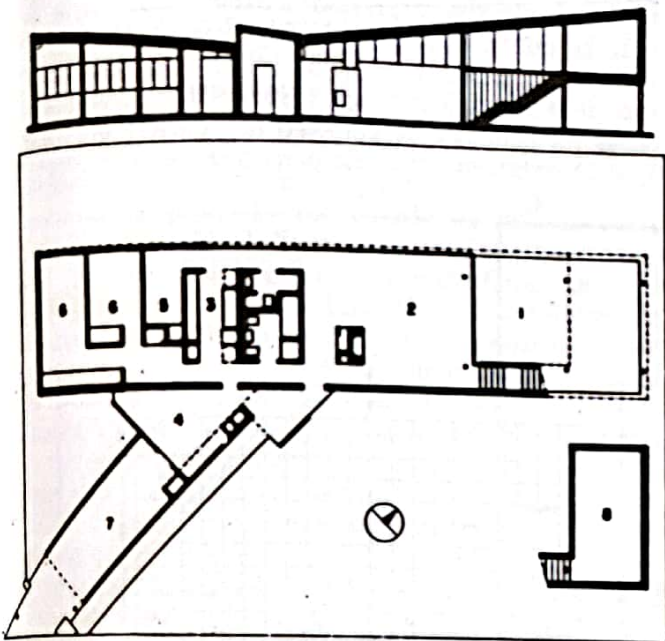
João VILANOVA ARTIGAS. Casa do arquiteto. São Paulo. 1948-1949. Planta e corte.
